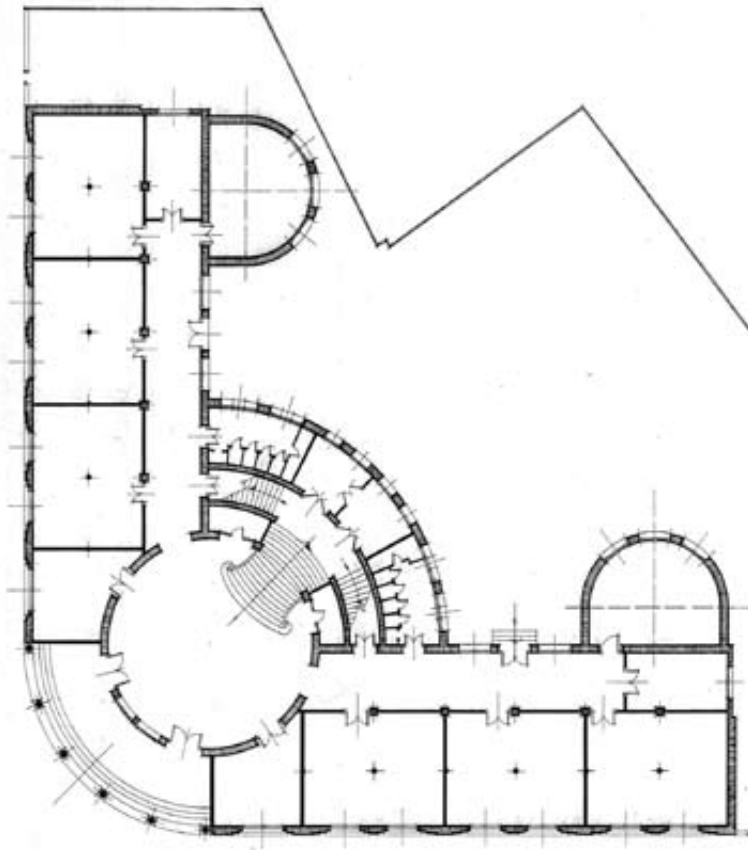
Planta baja del grupo escolar Gascón y Marín, Zaragoza, estado en 1980 (Archivo de la Dirección de Servicios de Arquitectura, Ayuntamiento de Zaragoza).
